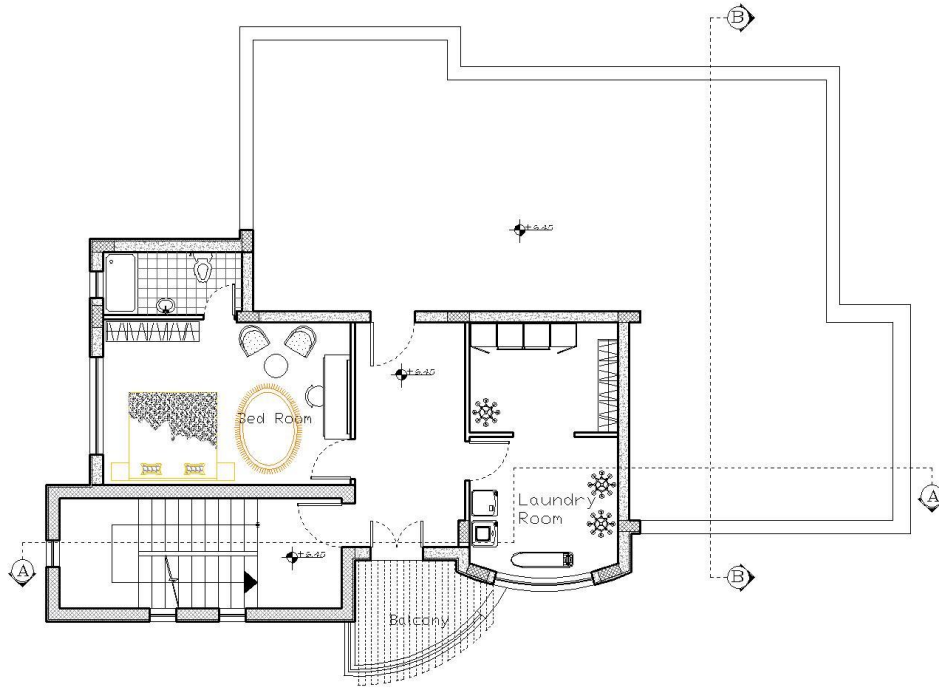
المسقط الأفقي للطابق الأول.
